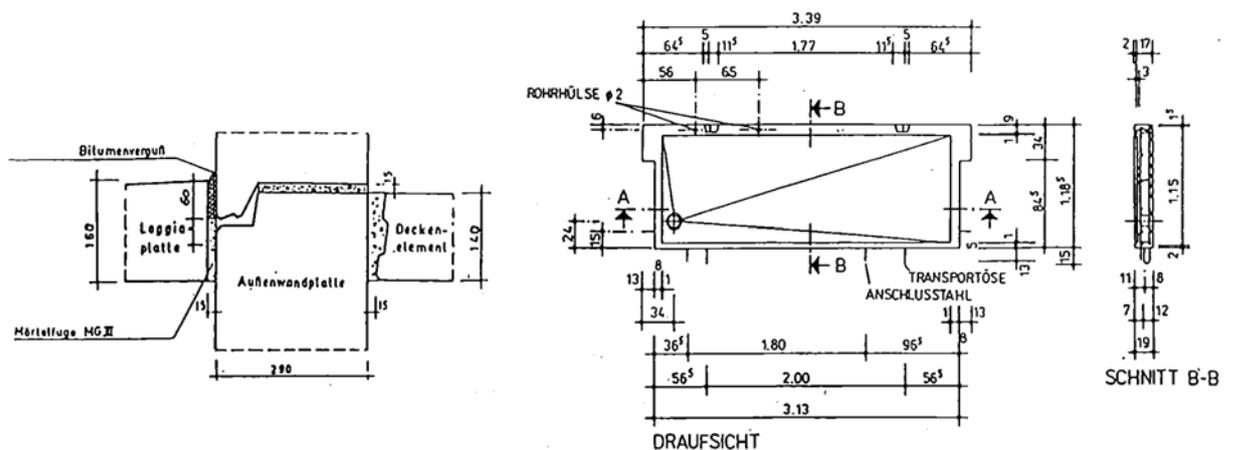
Detail Anschluss Loggia/Außenwand/Trenndecke PH12
